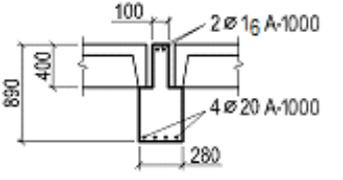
Изменение характеристик сопротивления железобетонных стропильных балок пролетом 12 м. с преднапряженной арматурой ($\sigma_{sp} = 900$ МПа) при предварительном сжатии арматуры сжатой зоны.
